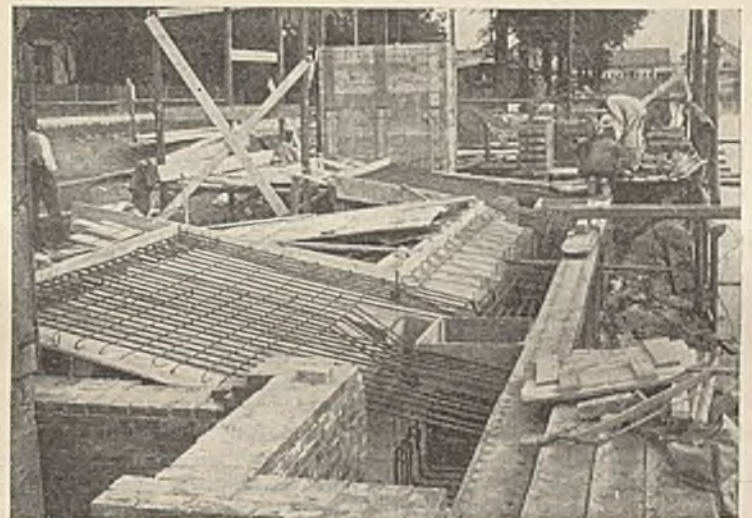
Fußsteigunterstützung und Gegengewicht (eingeschalt).
